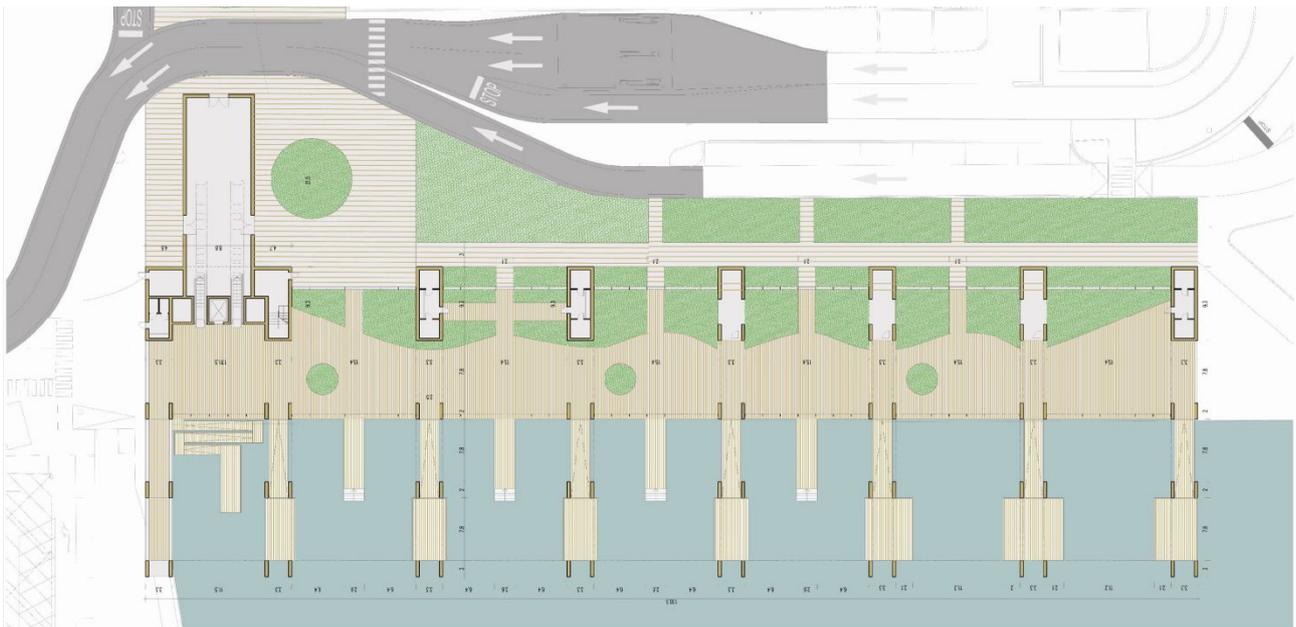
Pianta dell'edificio presso la darsena: piano terra
